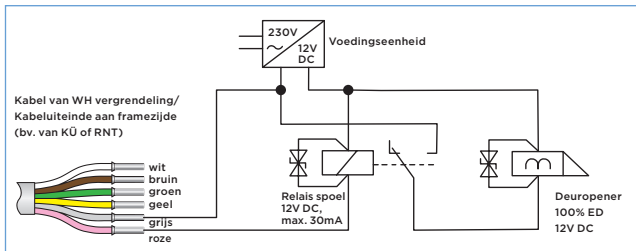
Algemeen aansluitplan met draaideuropener
